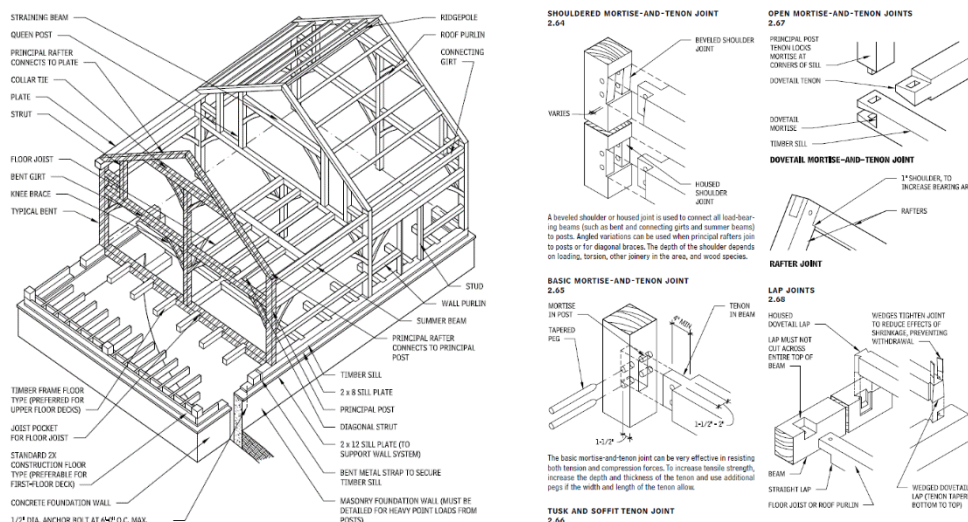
Sistema porticado do tipo "timber-frame" e respectivas ligações de encaixe (American Institute of Architects, 2008).
